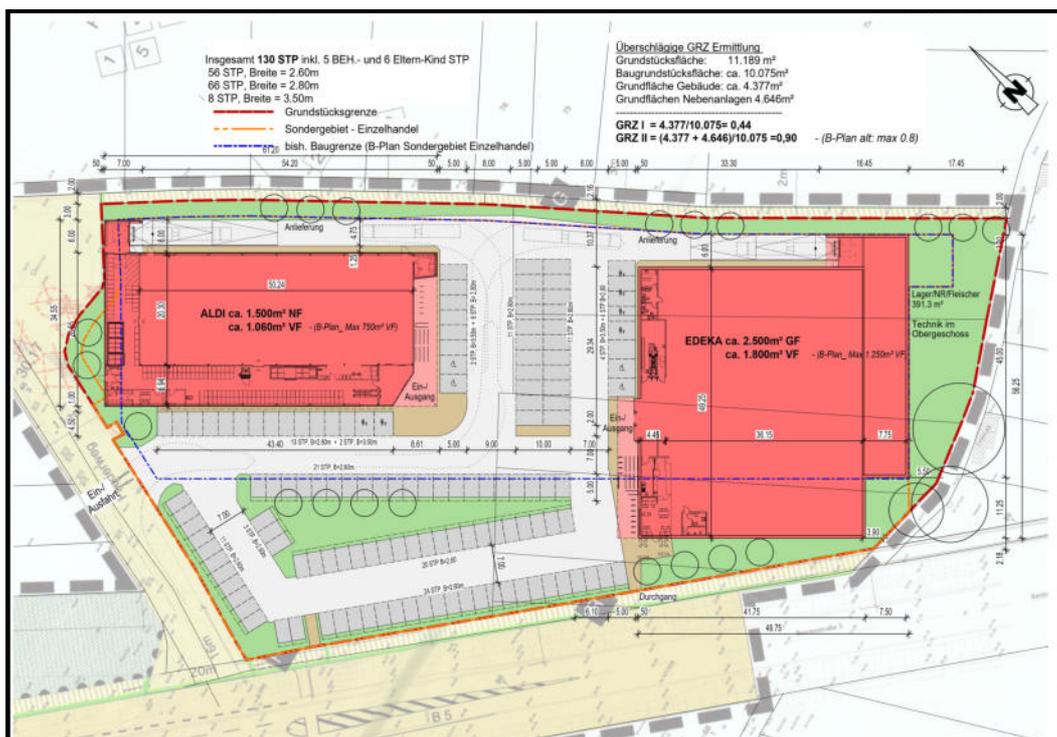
Planzeichnung mit Grundriss der neuen Gebäudehallen von Aldi und Edeka am Fliederweg
